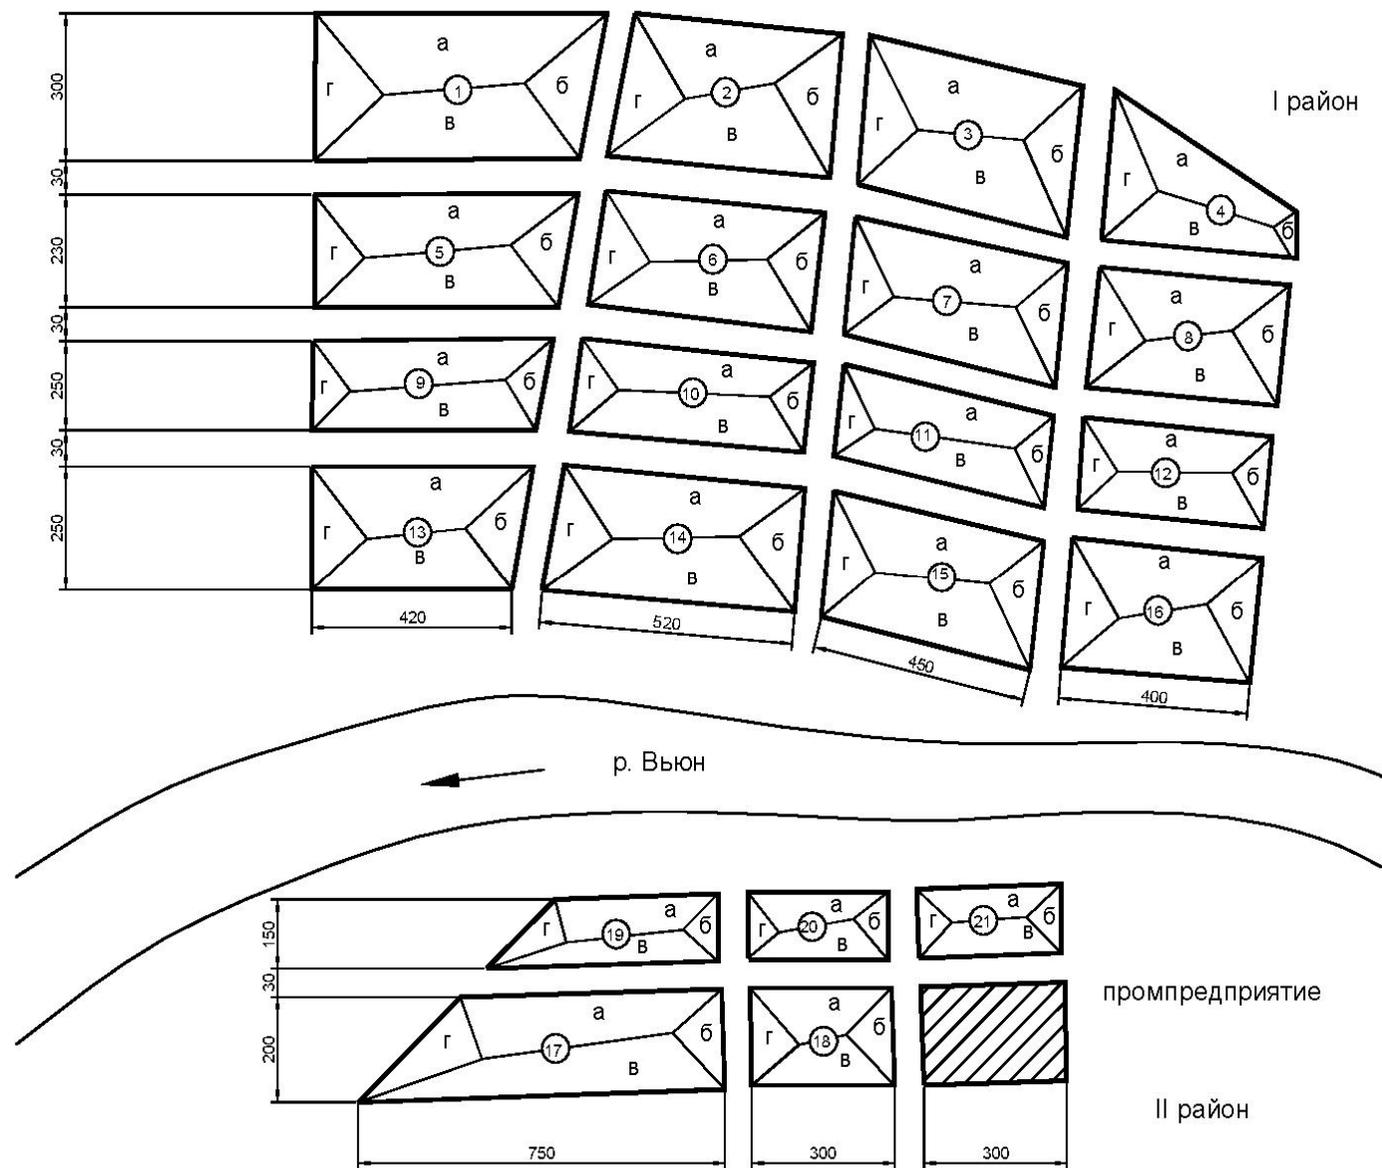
Генплан населенного пункта с разделением на площади стока
